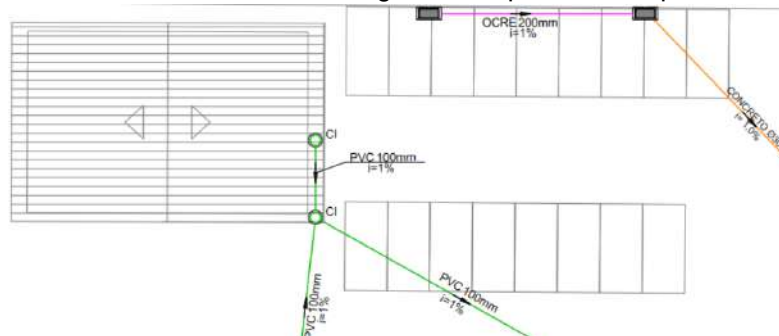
Planta de implantação do sistema de esgoto do empreendimento.
